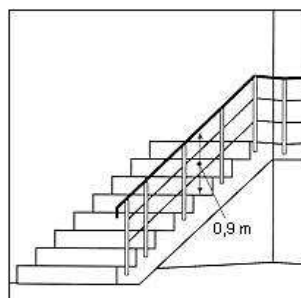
Escalera protegida con barandales complementado por dos barras intermedias
